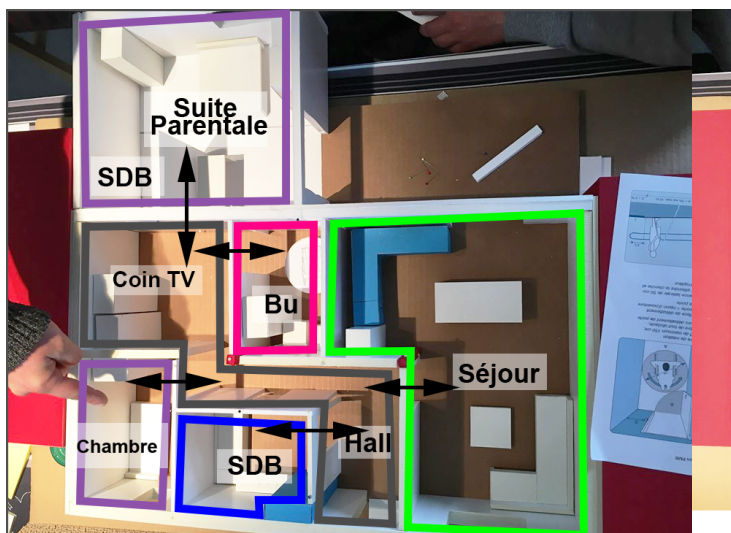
Photo du rez de chaussée après la phase 2 (Atelier V2)
